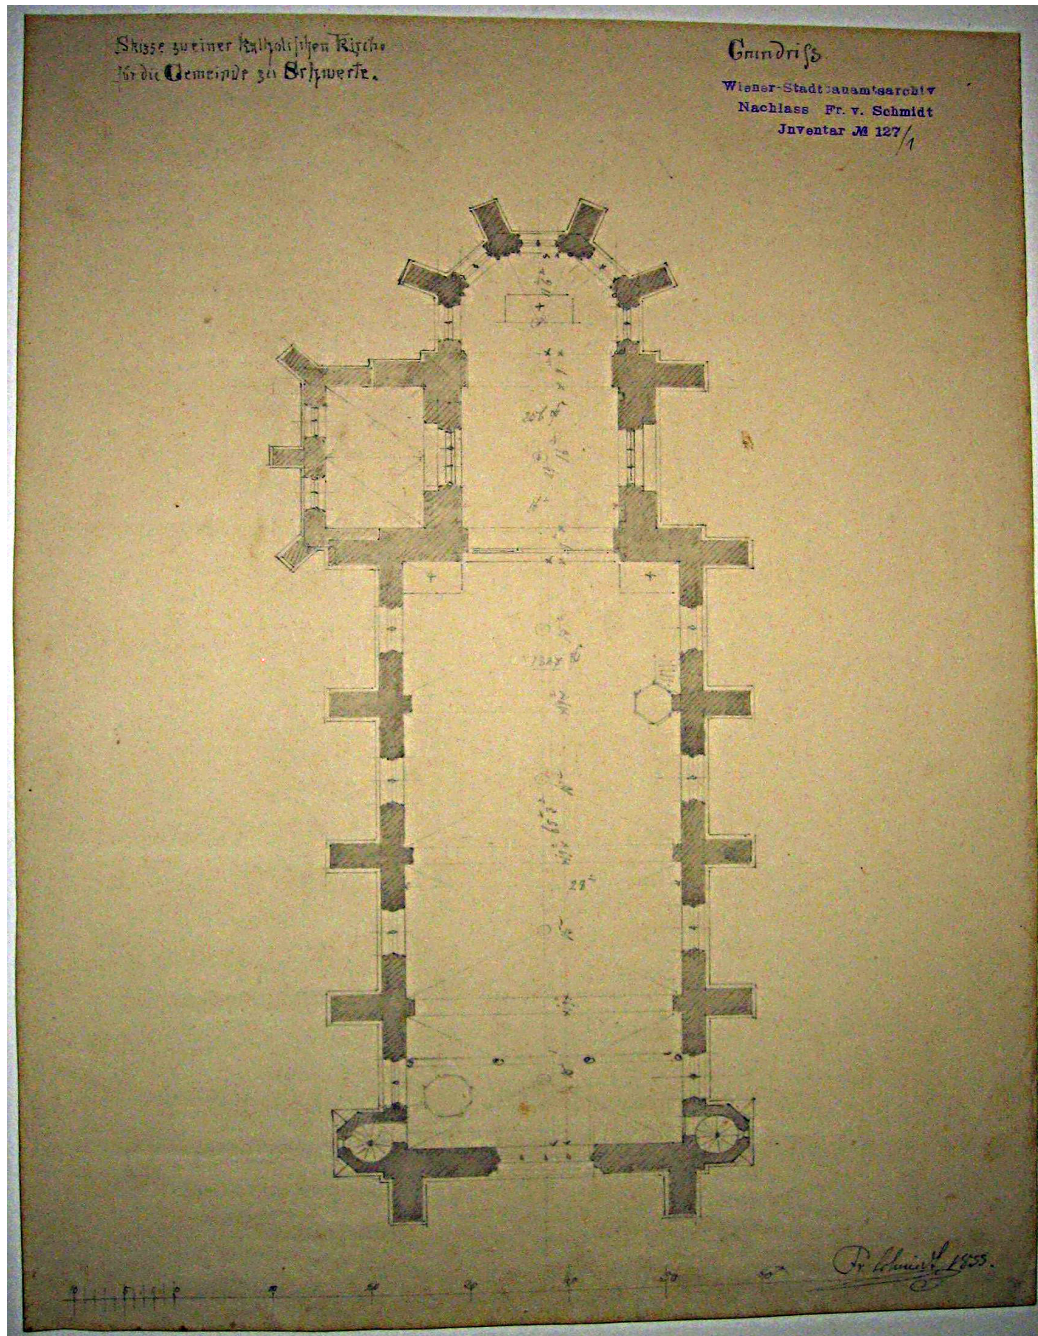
WM, Inv.-Nr. 157.127/1 Grundriss
